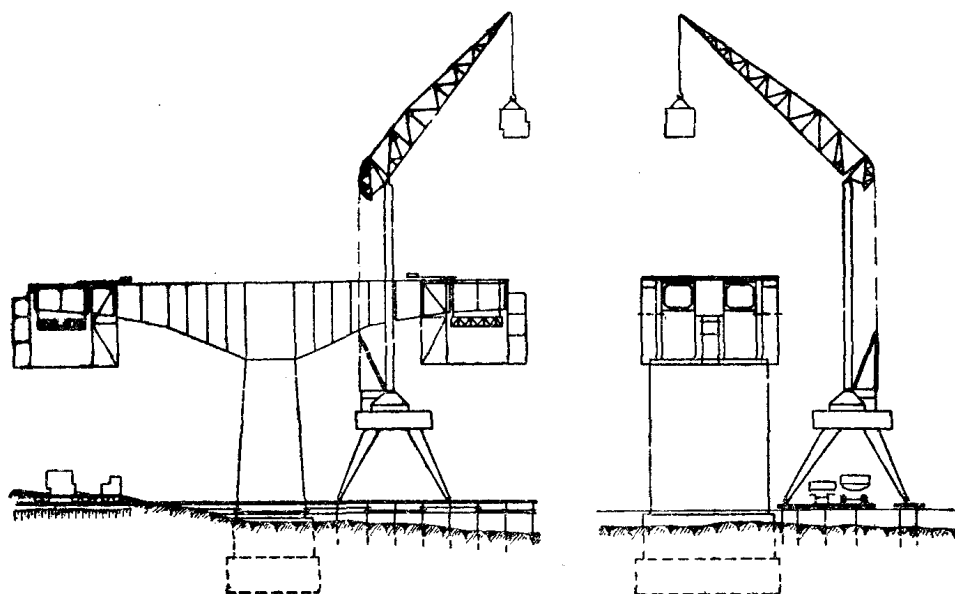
Схема монтажа пролетных строений башенным краном БТК-100
